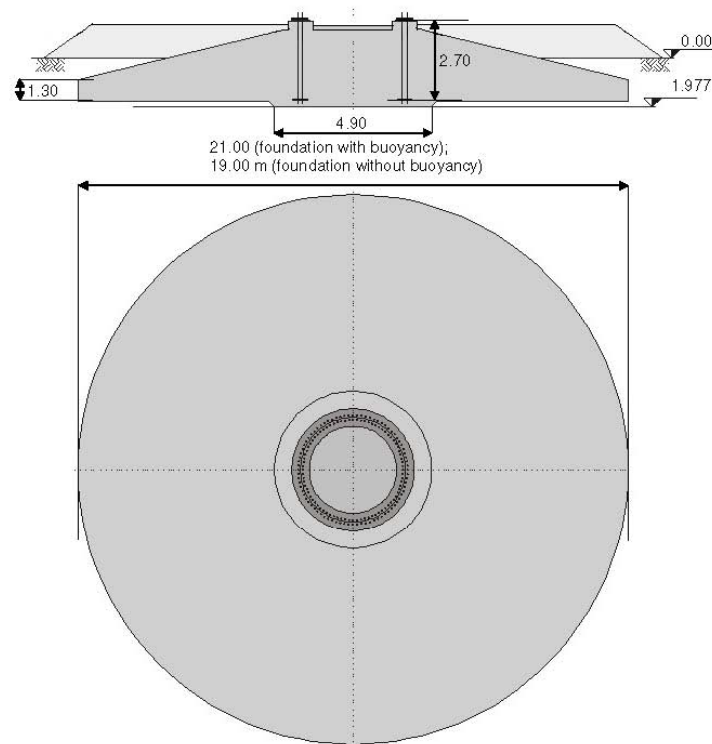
Vue en coupe des fondations (source : Nordex, 2013)
